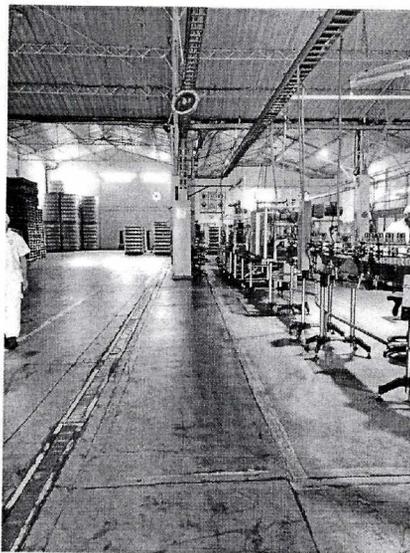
Vista general de losa maciza de apoyo para la instalación del Robot
